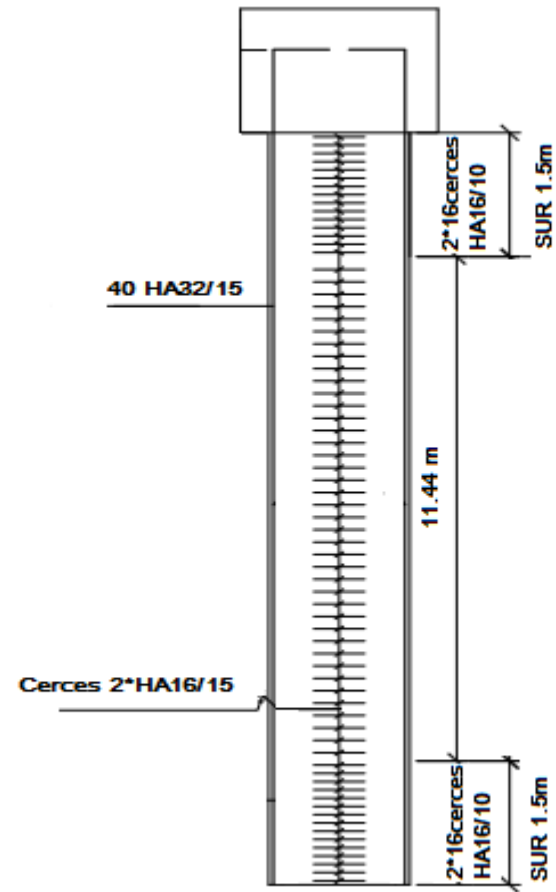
Coupe 2 sur le plan de ferrailage du FUT
